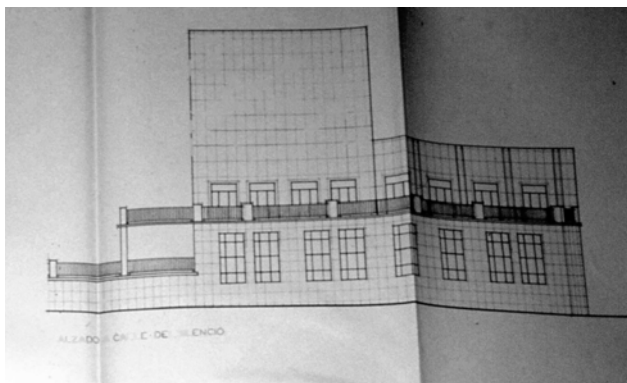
C. M. Santa María de los Ángeles: fachada a la calle del Silencio, por Fernando Población, diciembre 1961.
